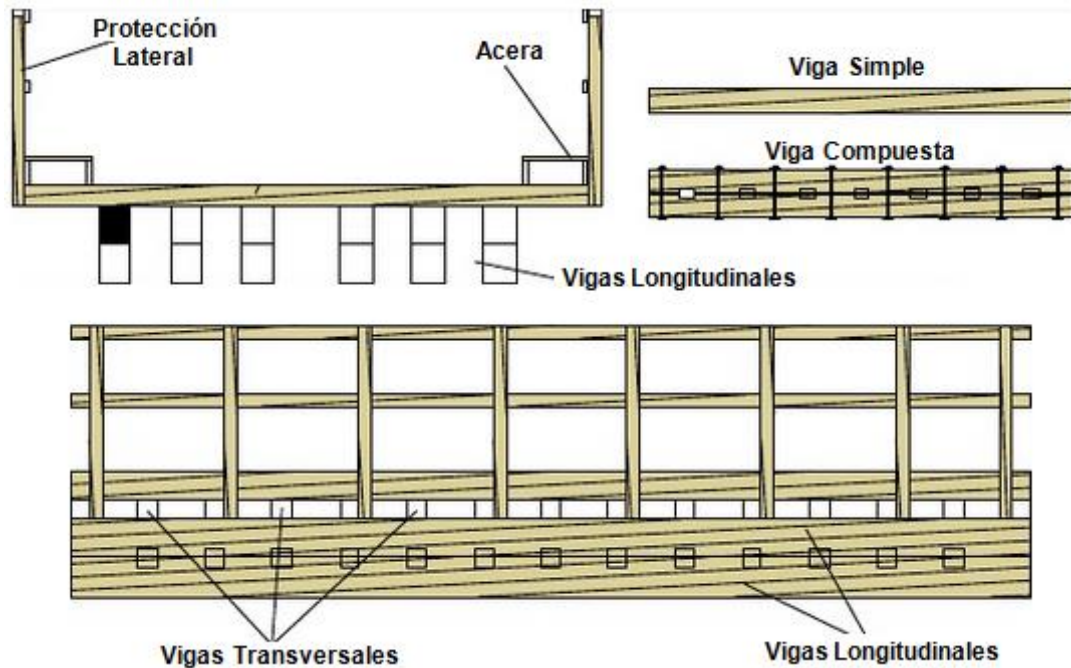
Sección transversal con vigas simples o compuestas [14]
